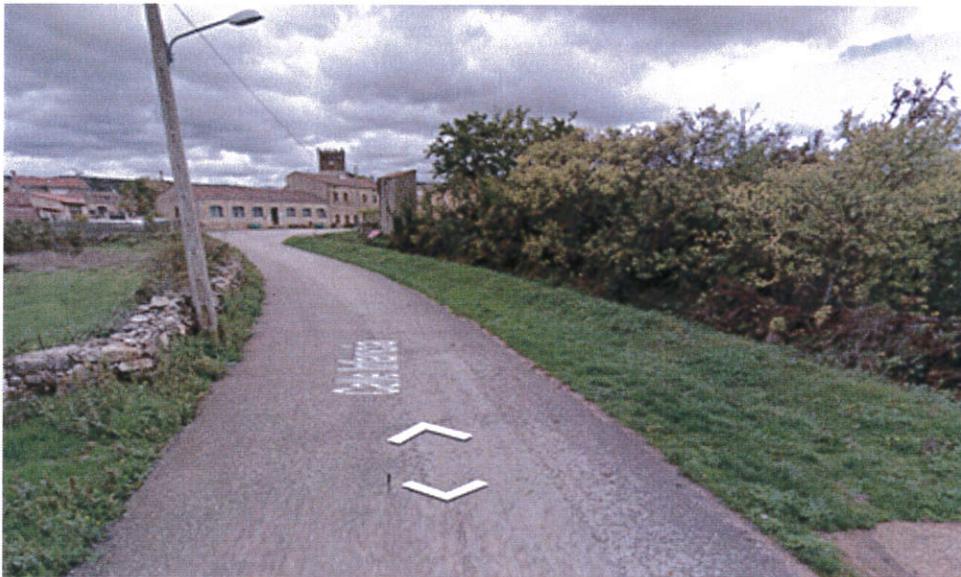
Vista del vial y zona lateral que no aparece en los planos de la documentación propuesta.
